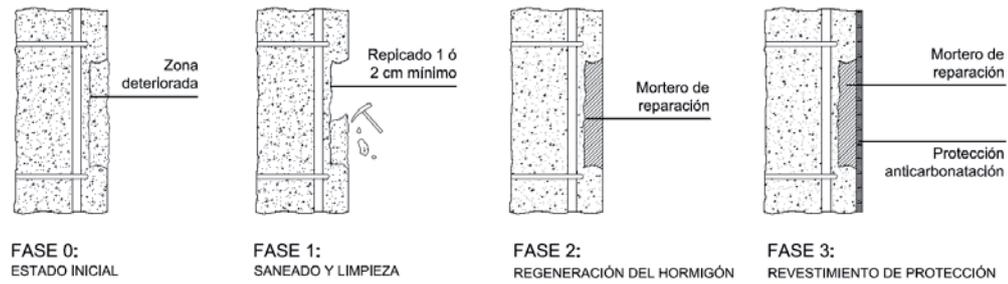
Fases de la reparación de pilares con hormigón en mal estado
